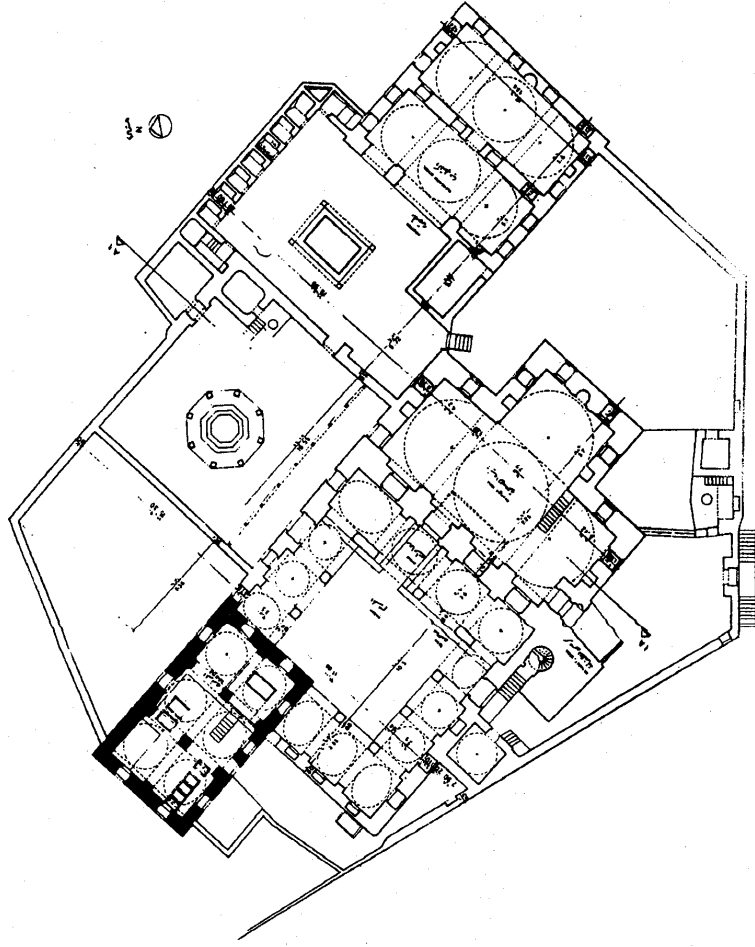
مسقط أفقي للقبّة الملحقة بجامع آلتى برمق بالقاهرة .
